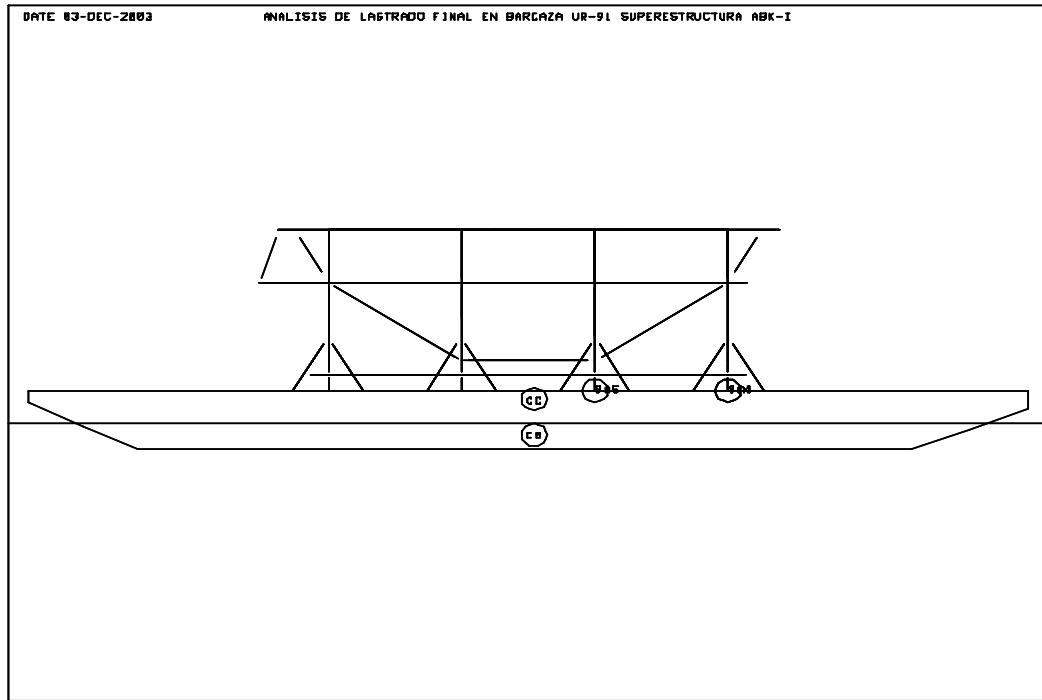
VISTA LATERAL DEL SISTEMA BARCAZA-SUPERESTRUCTURA
